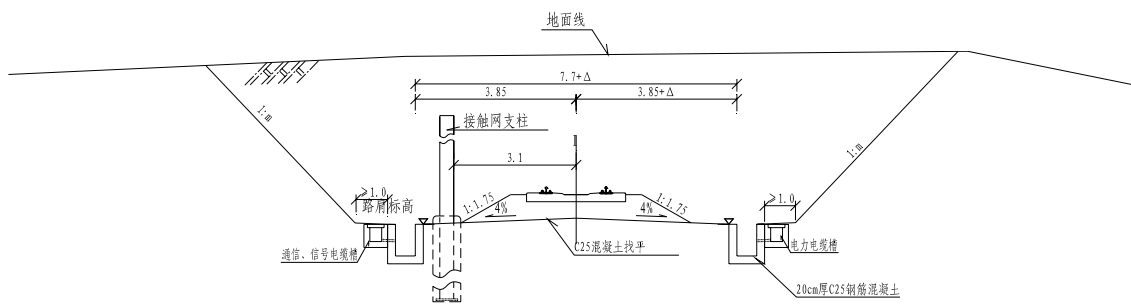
单线路堑标准横断面图 (硬质岩路堑地段)
